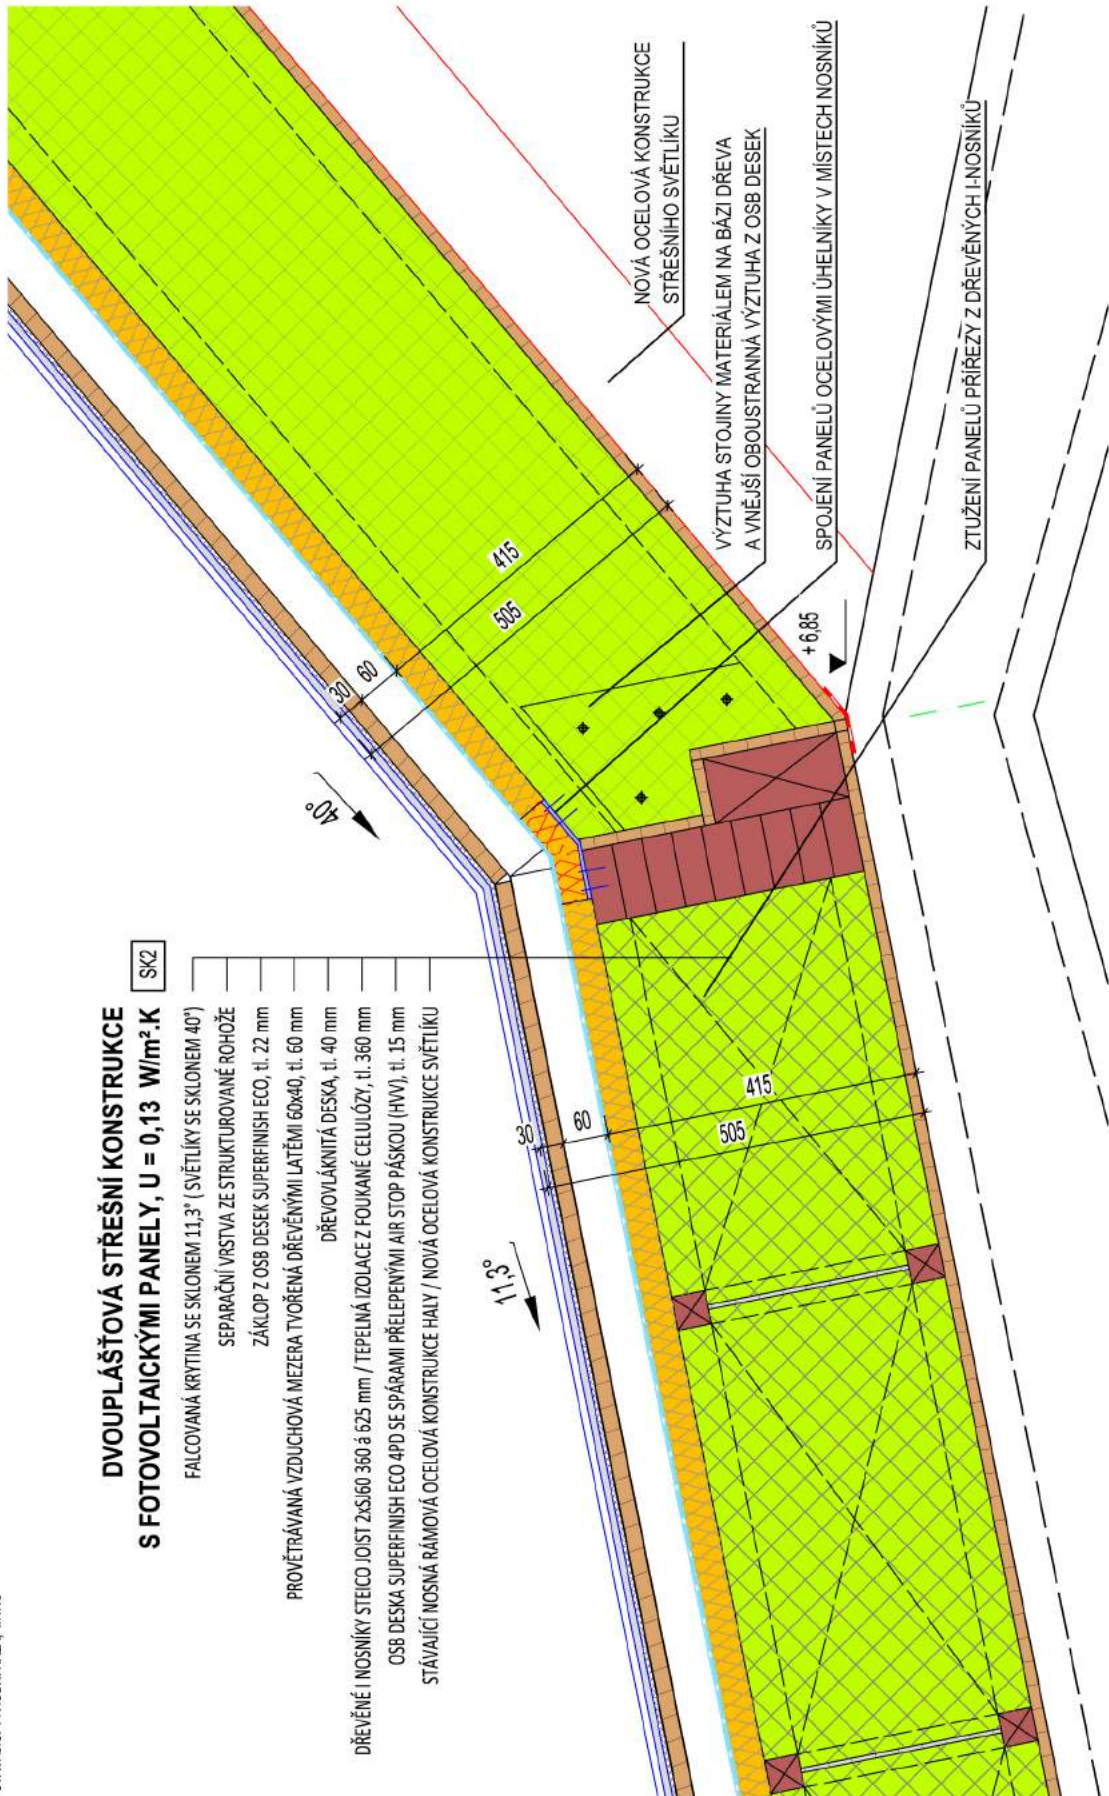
DETAIL E - NÁPOJENÍ STŘEŠNÍHO A SVĚTLÍKOVÉHO PANELU
